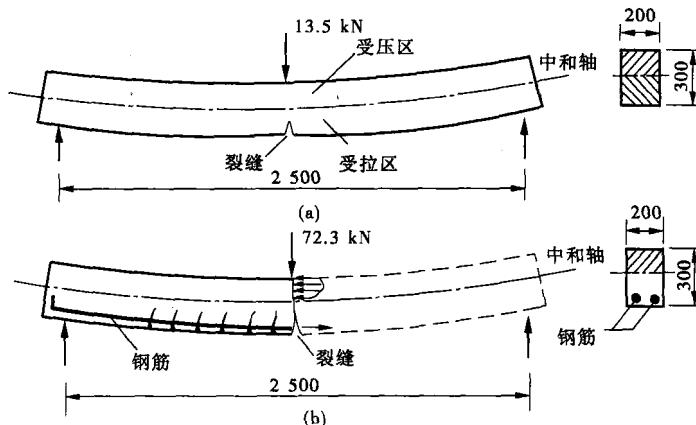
混凝土梁与钢筋混凝土梁的承载力对比示意图 (单位:mm)
